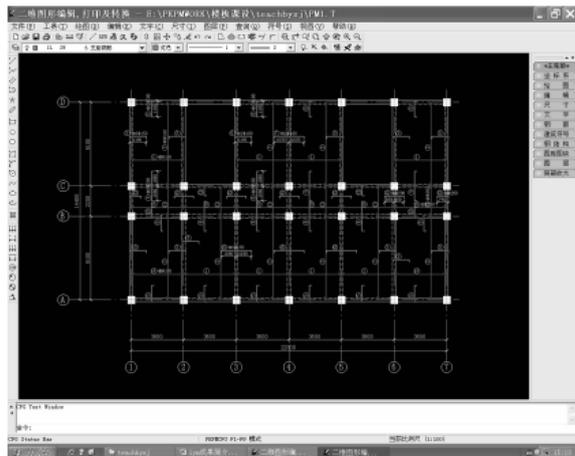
钢筋混凝土楼盖 PMCAD 配筋图
